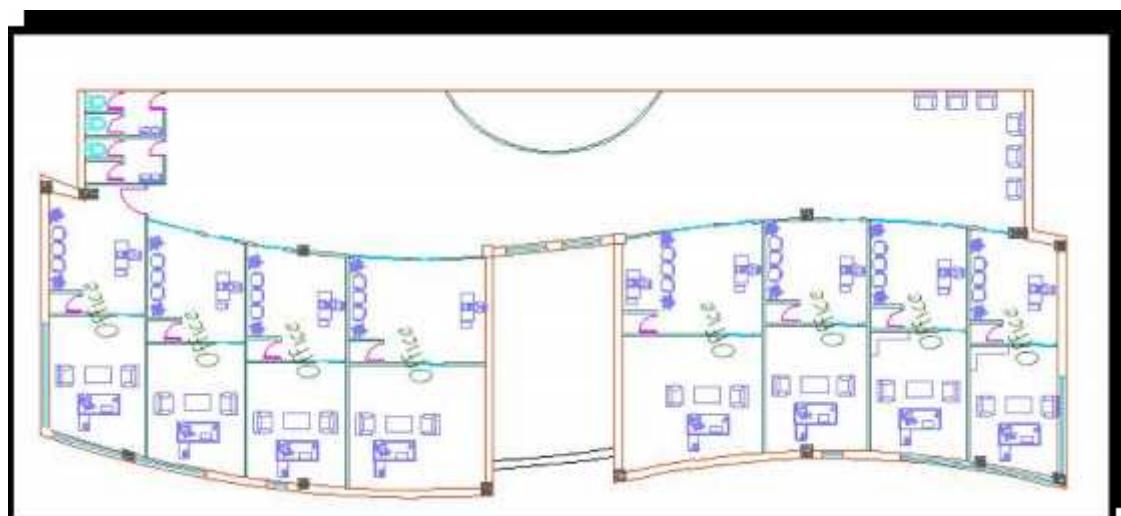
المسقط الأفقي لمحلات تجارية
